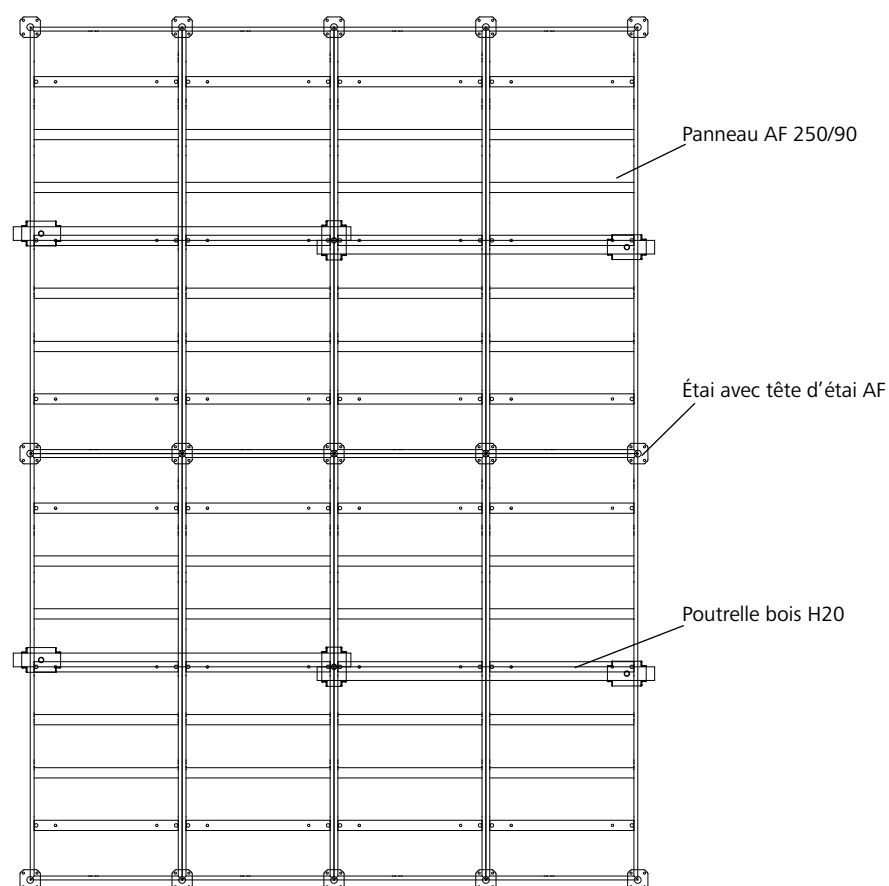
Poutrelle bois H20 utilisée comme poutre à une seule travée
